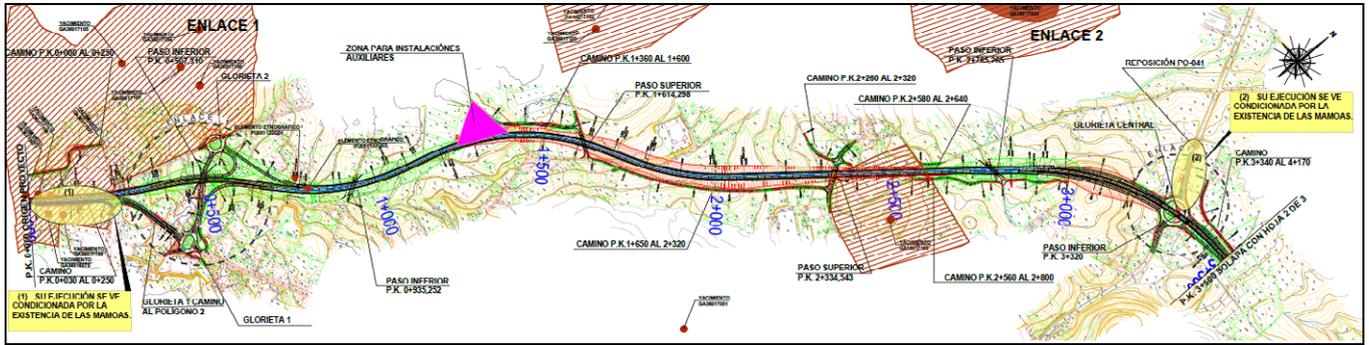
Plano de conjunto. Tramo 2 (km 4 al km 7).
